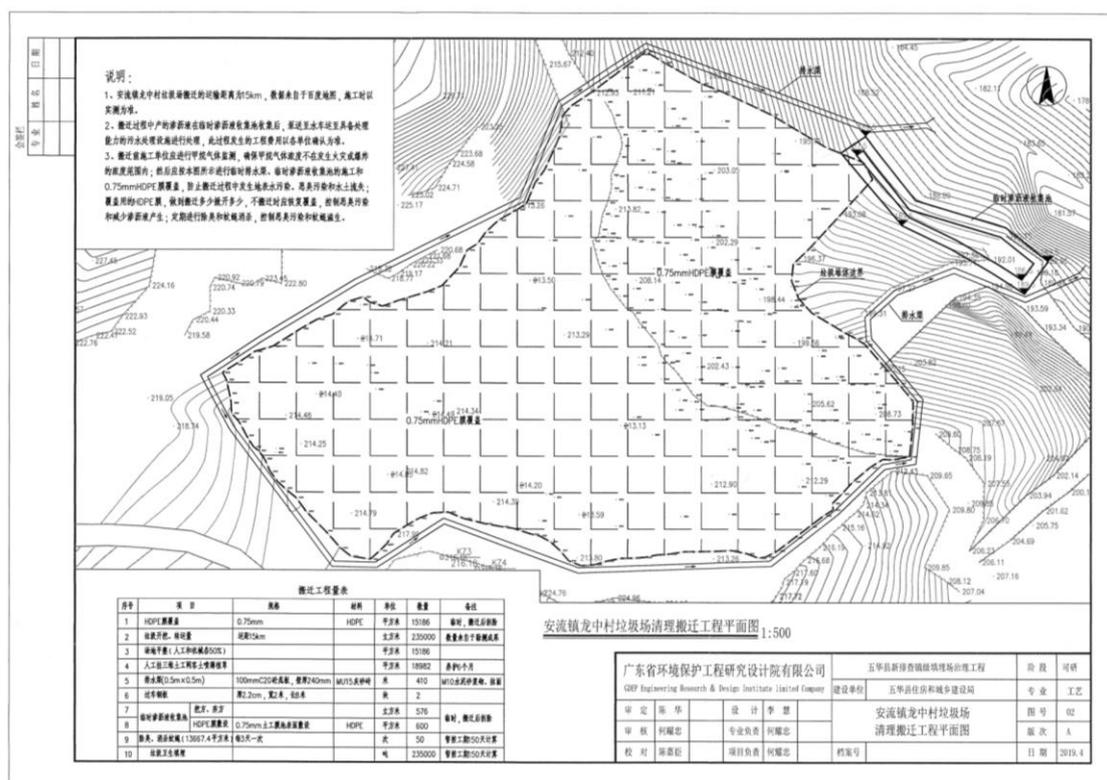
安流镇龙中村垃圾填埋场搬迁工程平面布置图
